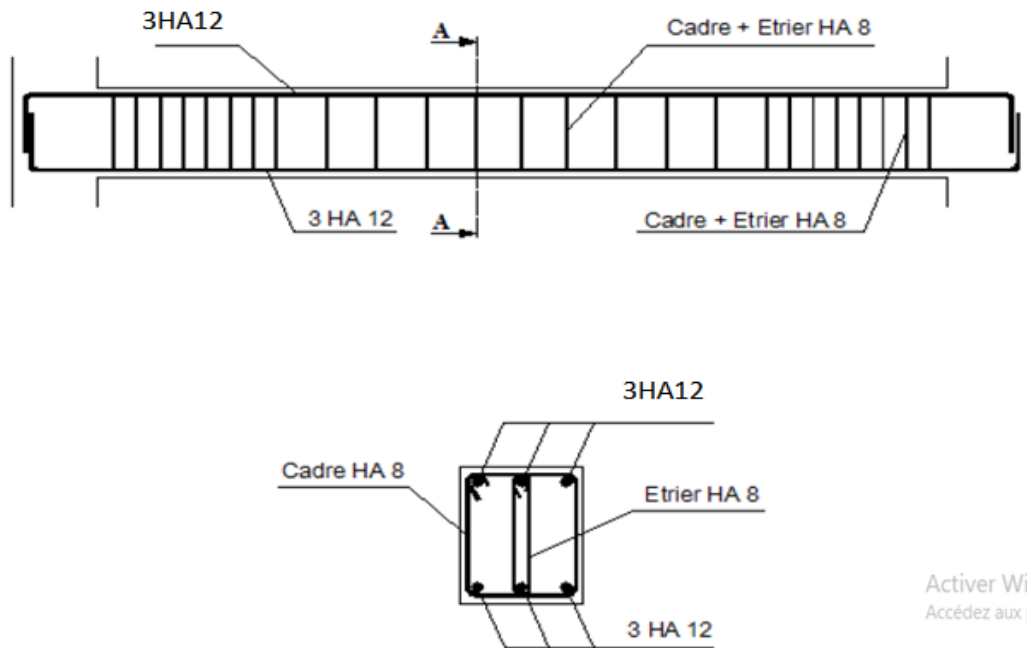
Ferrailage de la poutre de chaînage reposant sur deux appuis
